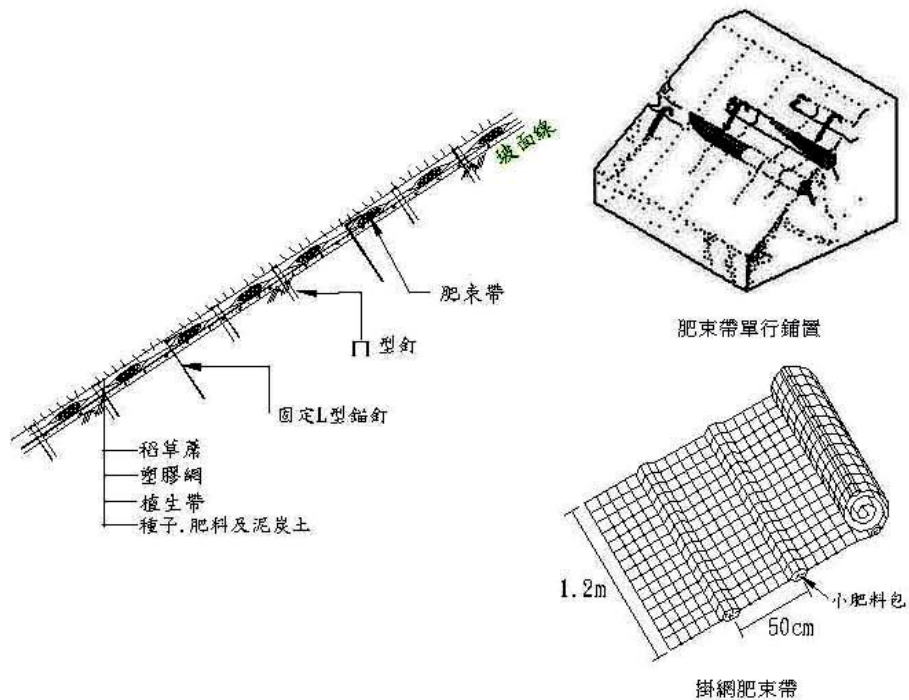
肥束帶（或類似產品）施工示意圖
